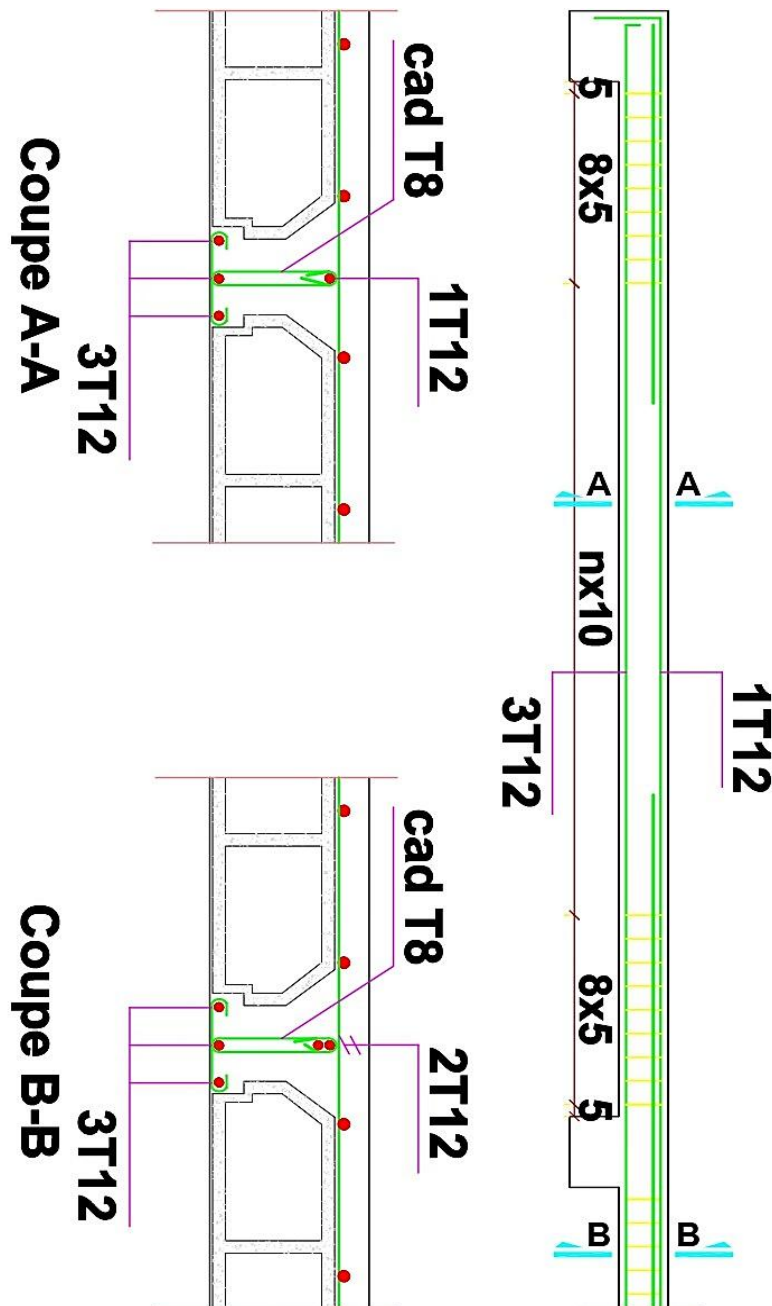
Schéma de ferrailage du plancher à corps creux
